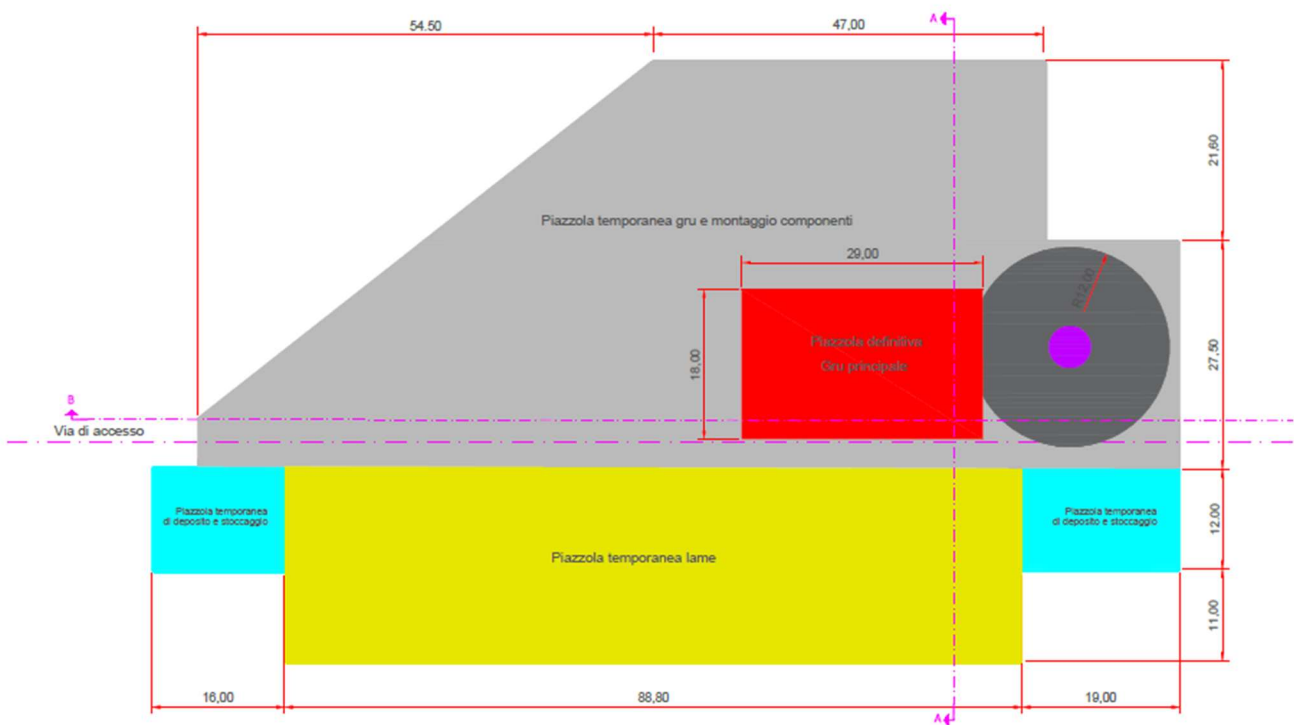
Parco Eolico E 90. Piazzole di fondazione standard in fase di progetto dell'impianto.
